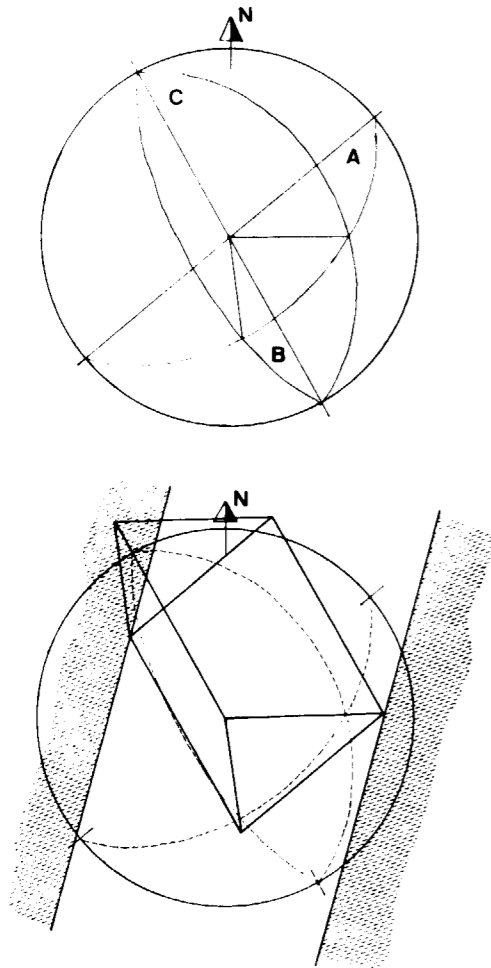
Caso de una intersección horizontal con bóveda plana, aparecen prismas triangulares en la clave, que precisan de un plano repetido para su formación.
